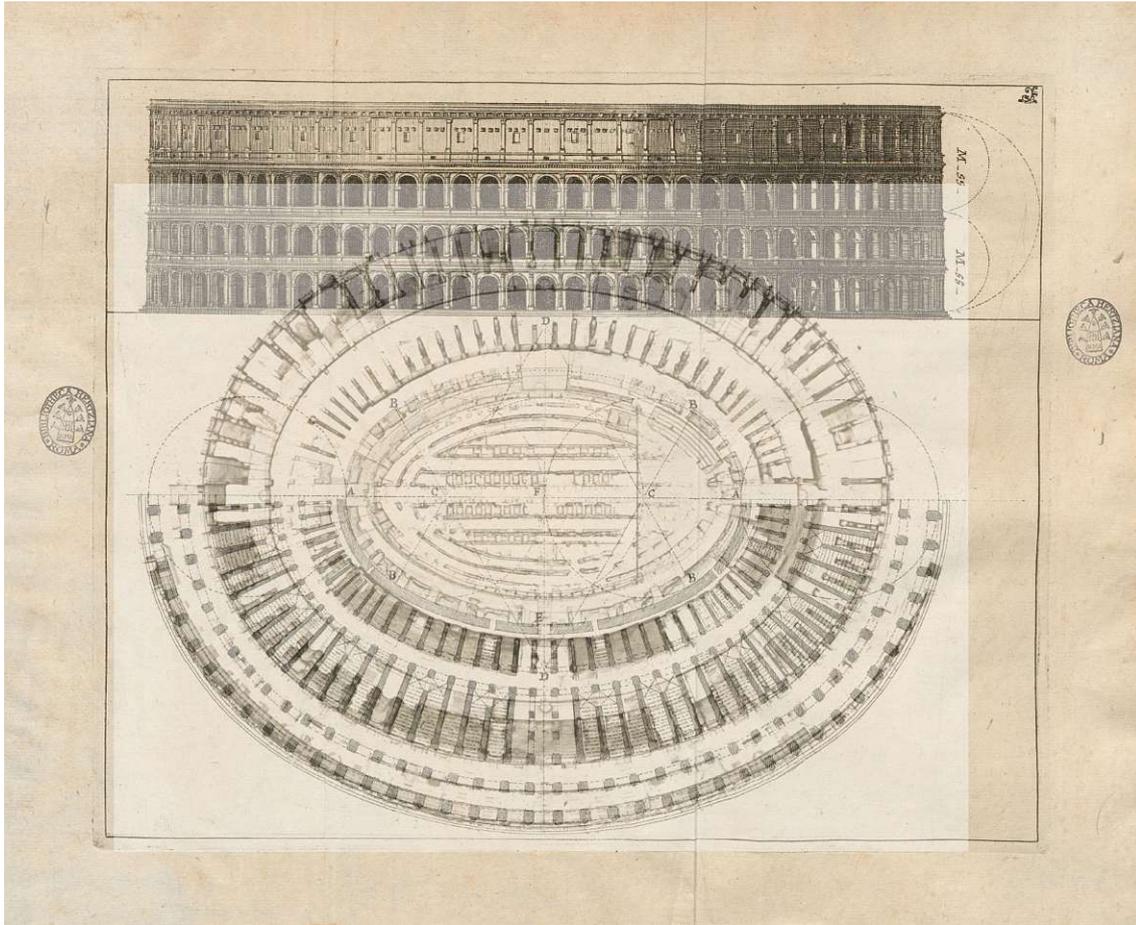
Überlagerung von Guiseppe Maria Ercolanis Konstruktionsweise und dem tatsächlichen Grundriss des Kolosseums
